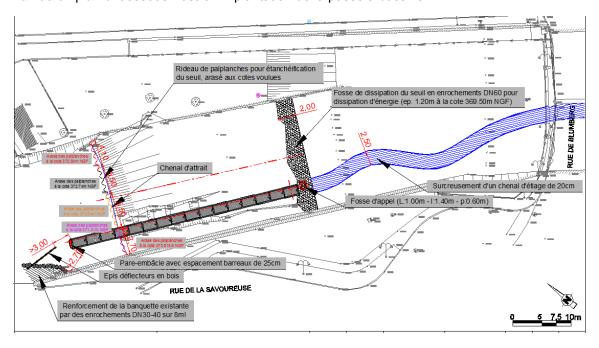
Vue en plan de la passe à bassins projetés au droit de l'ouvrage ROE15924
